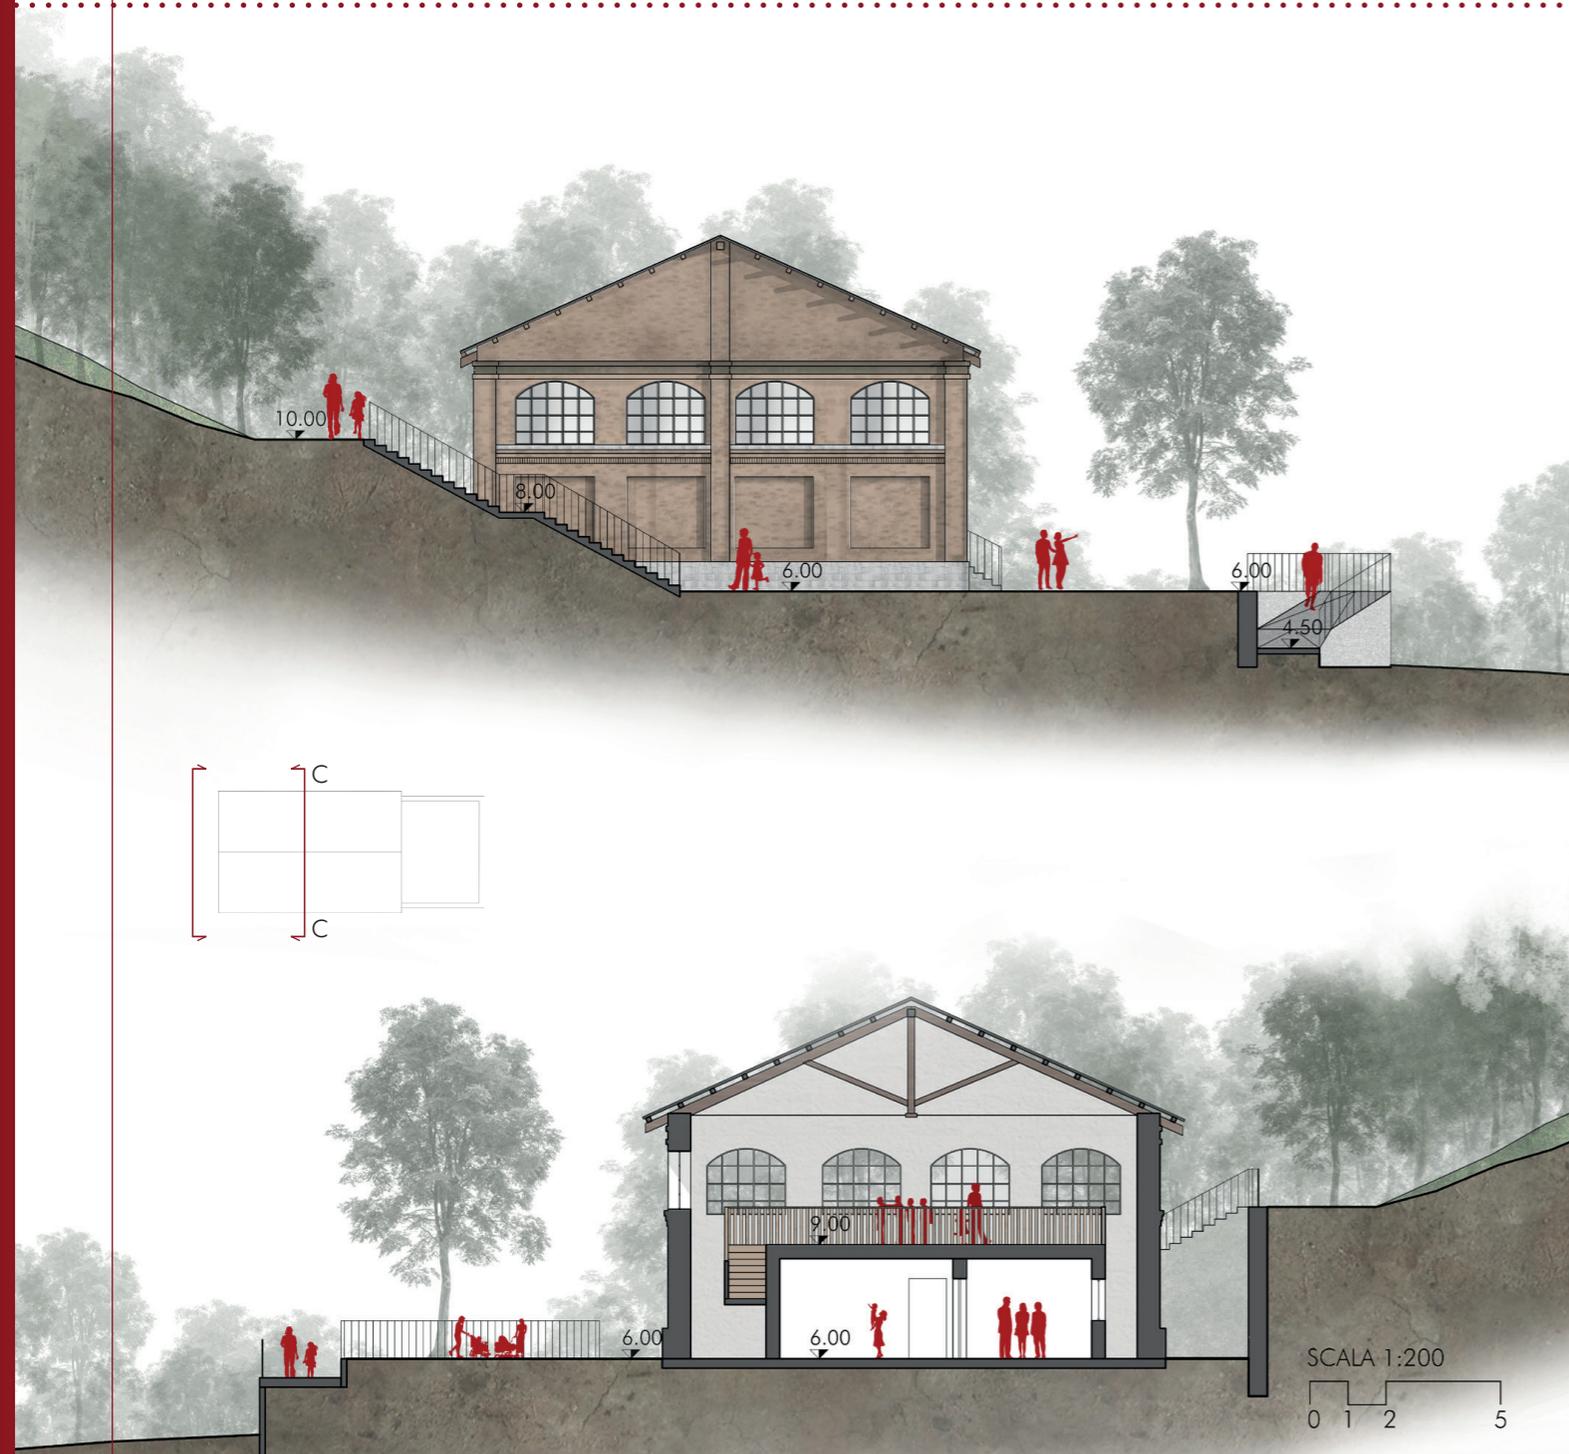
Prospetto nord-ovest e sezione CC del polo centrale dell'escape room, elaborazione delle autrici
